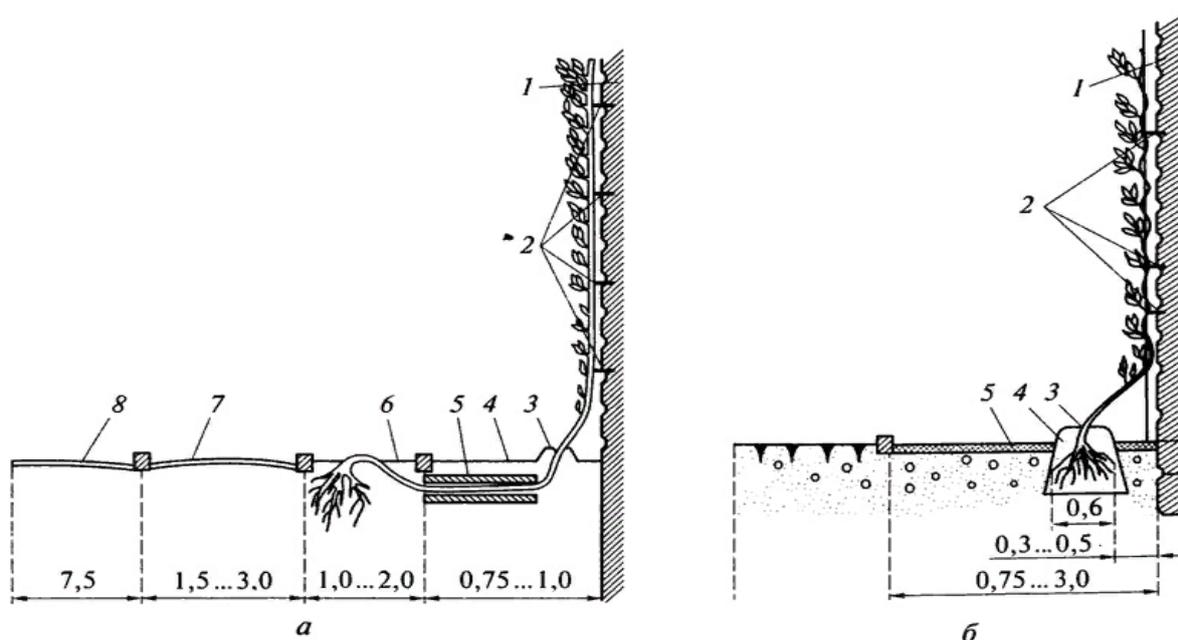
Схемы размещения и посадки лиан у стен зданий (размер, м):
